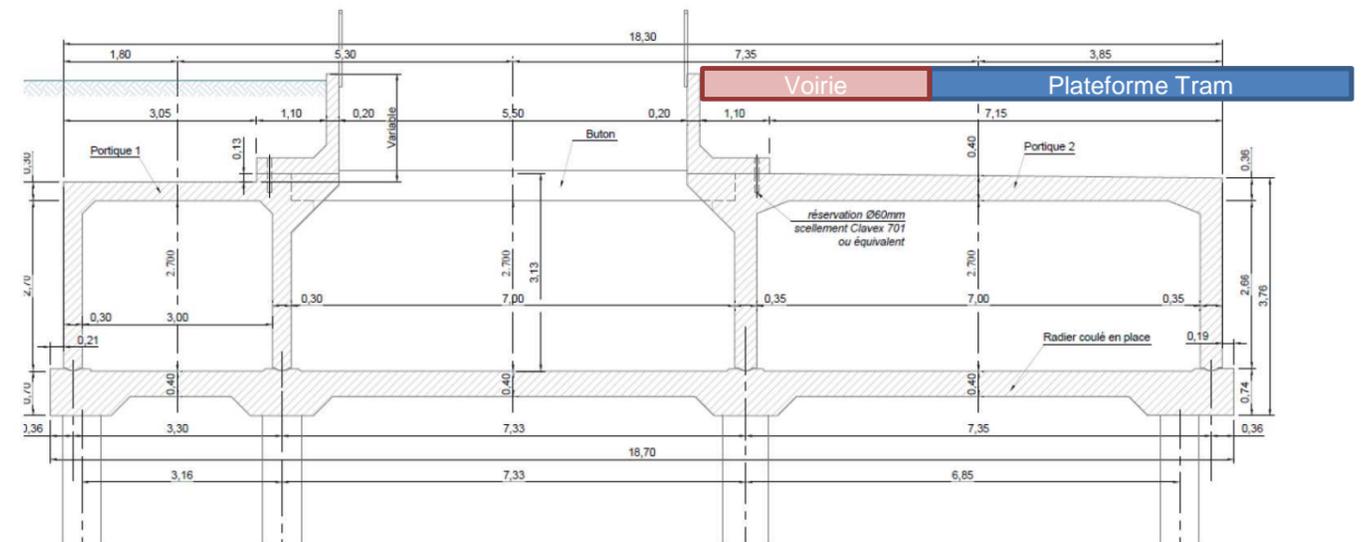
Coupe en travers de l'ouvrage des Aygalades actuel (avec indication de la position de la PF Tram)
